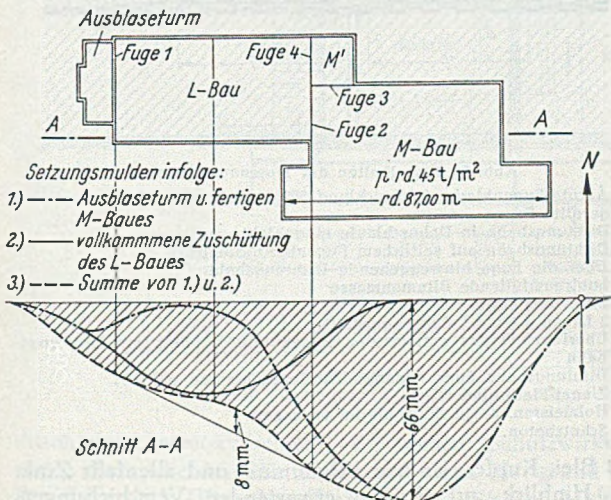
Lageplan und Setzungsmulden infolge Einschüttung der Bauteile.
